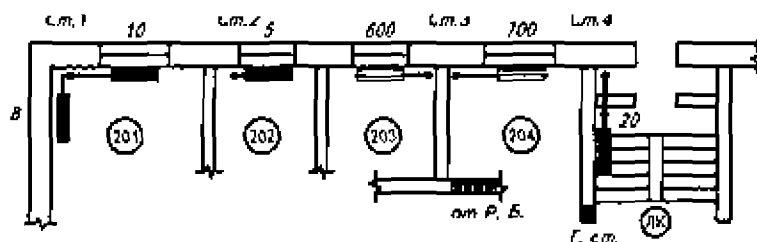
Варианты размещения стояков, подводок и отопительных приборов на поэтажных планах здания.
